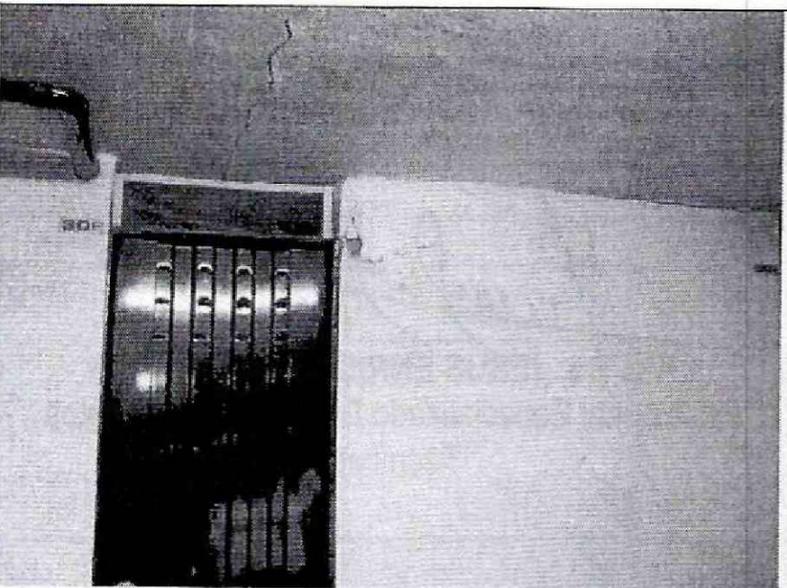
Daños en muros, desprendimientos y grietas.
